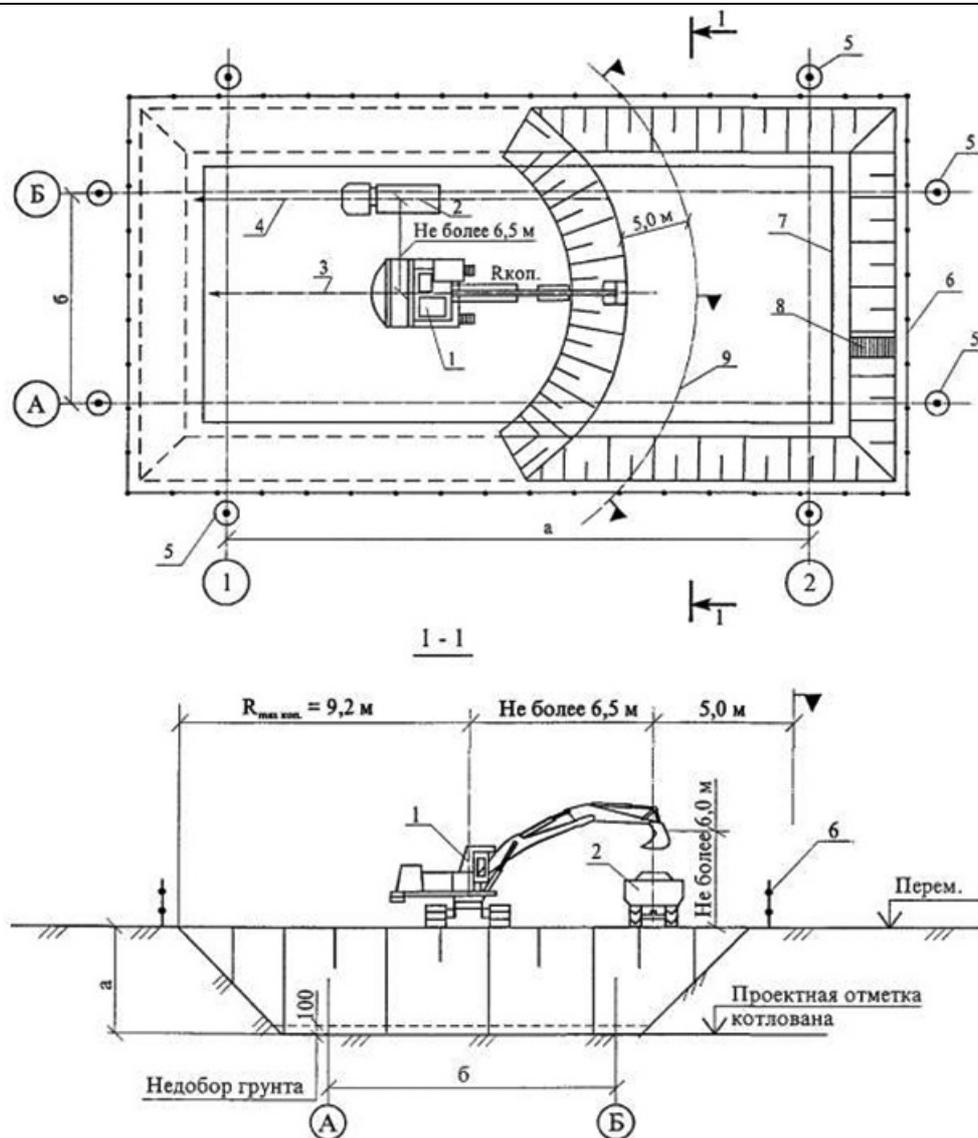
Схема разработки грунта котлована экскаватором при лобовой проходке
